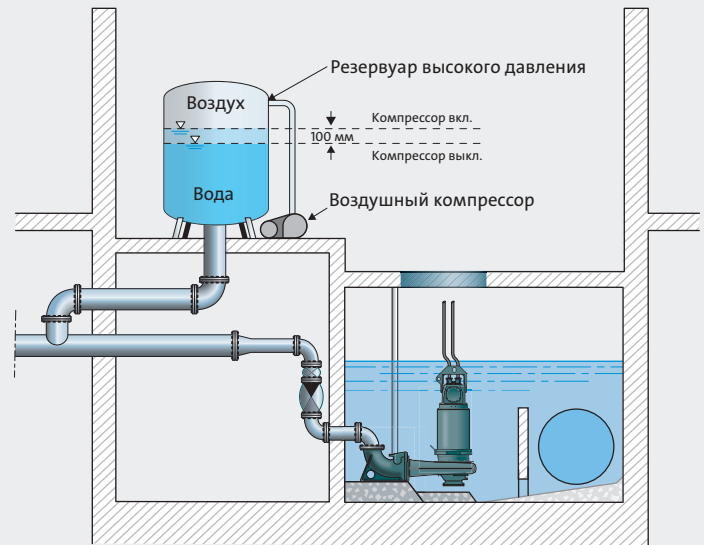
Принцип работы воздушной камеры повышенного давления компрессорного типа.
